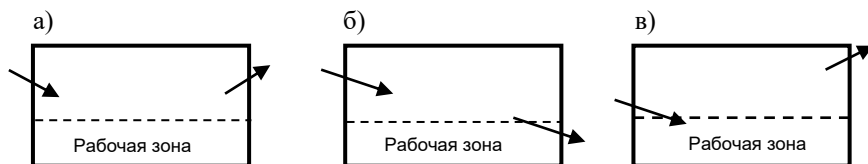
Схемы движения воздушных потоков в вентилируемом помещении: а – сверху-вверх; б – сверху-вниз; в – снизу-вверх
